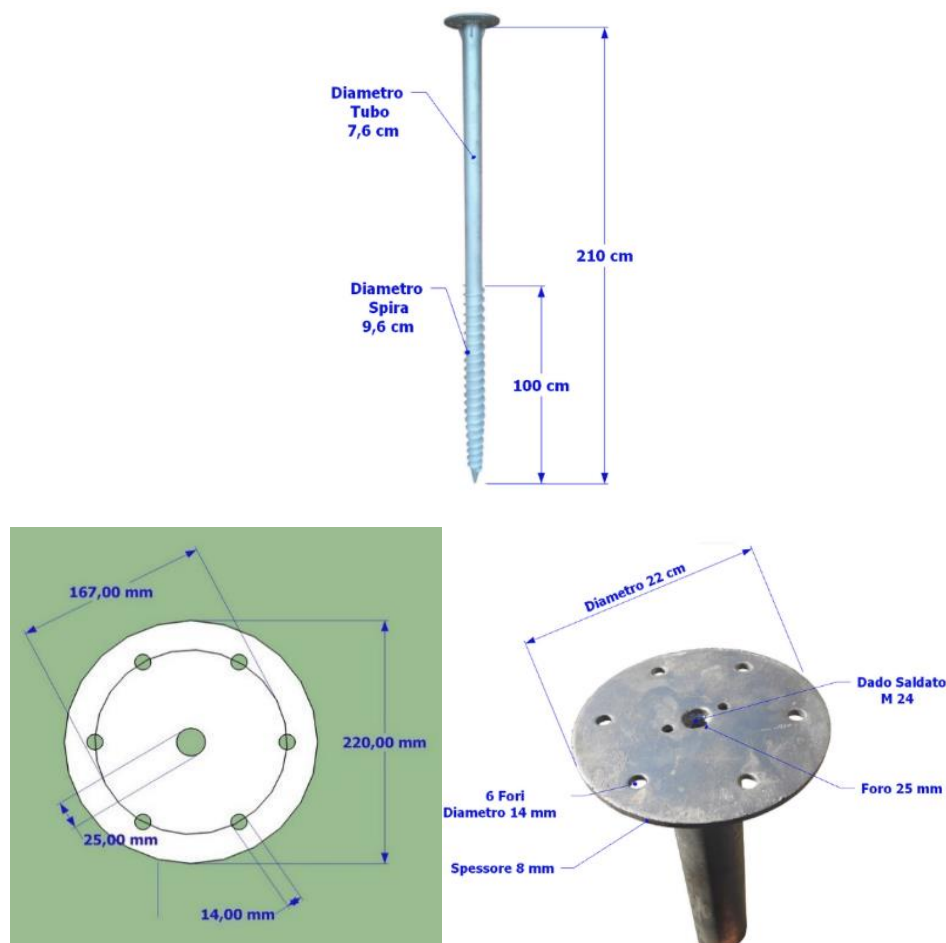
Tipologia di fondazione a vite per strutture Tracker
